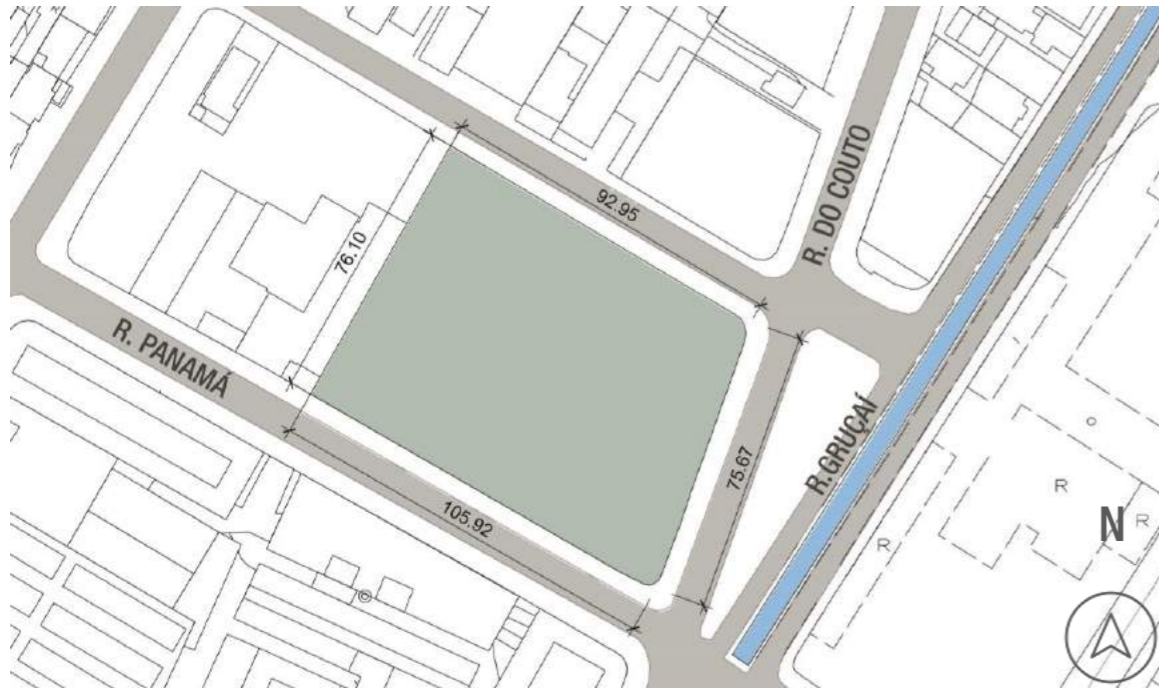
Planta de Situação. Fonte: Cadastral Rio de Janeiro
